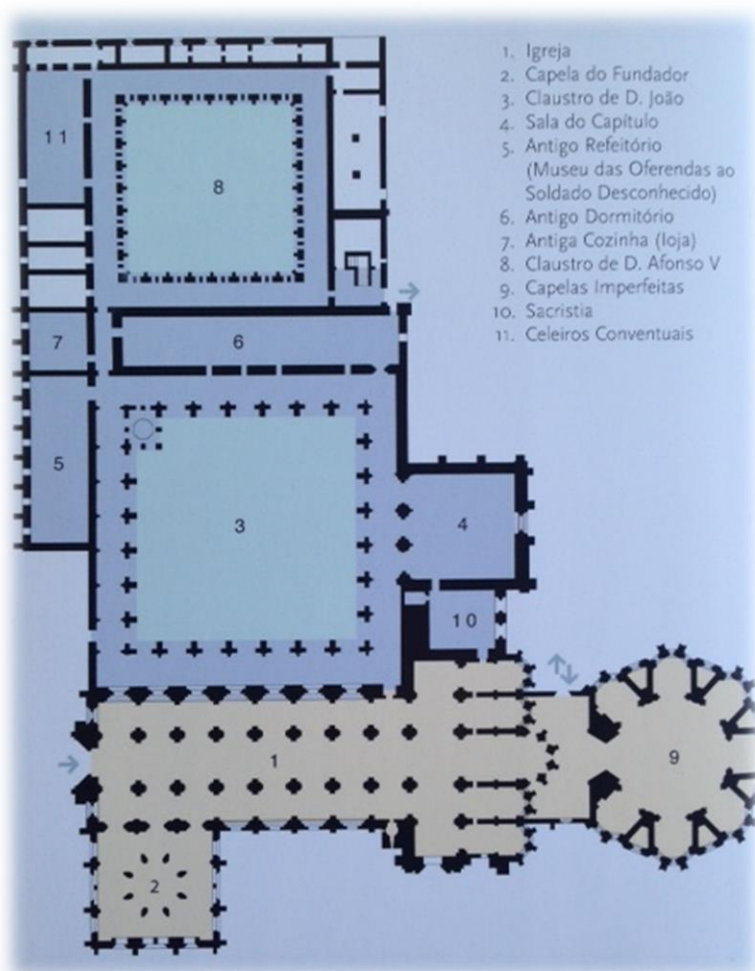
Planta do Mosteiro da Batalha (Silva & Redol, 2007)
